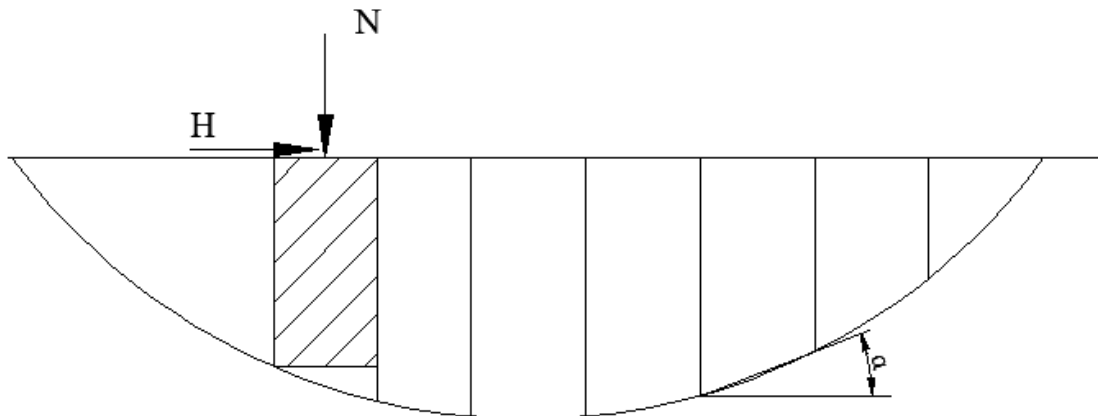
Расчетная схема определения устойчивости фундамента:
